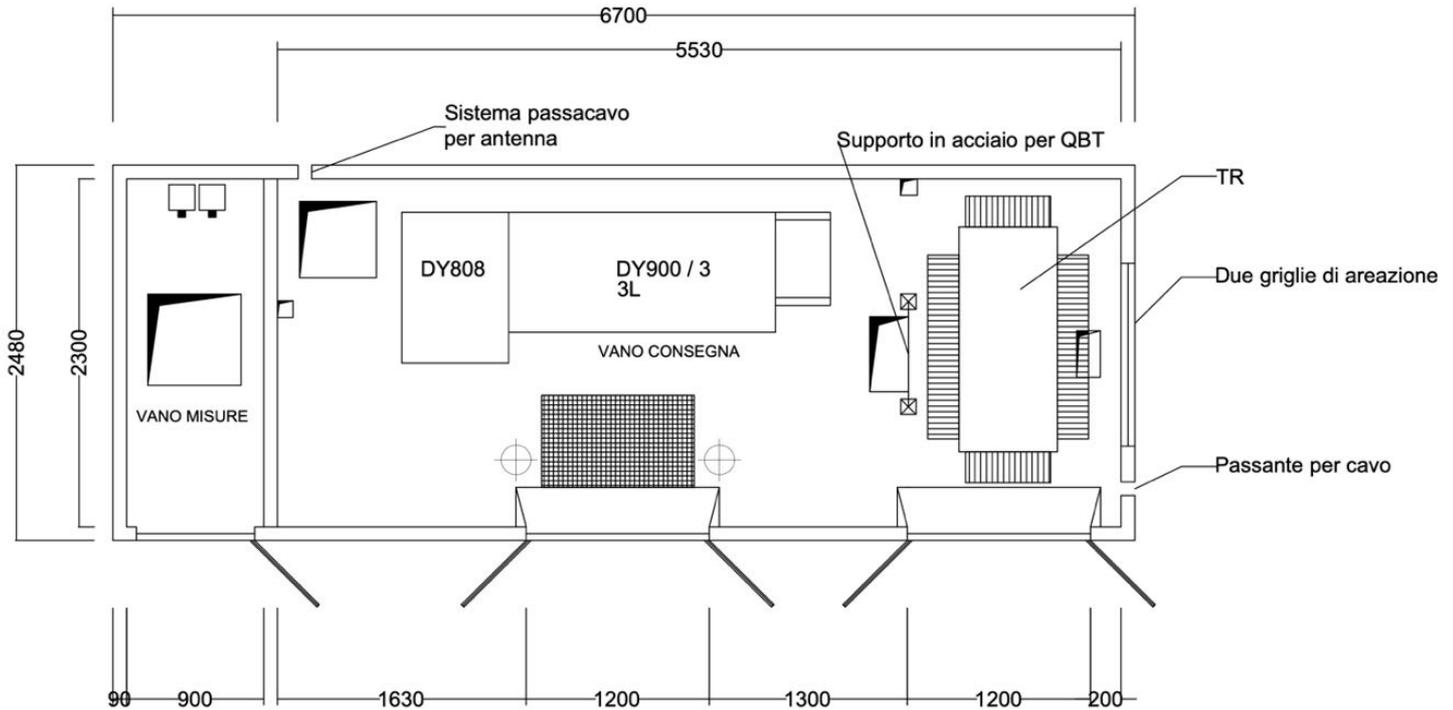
Tipologico planimetria cabina di consegna DG2061/7 ed. 9
